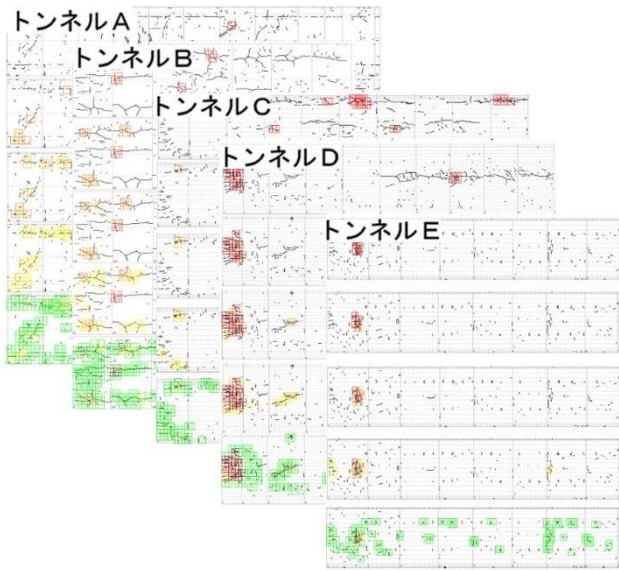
ひび割れ密集度の主観評価について
